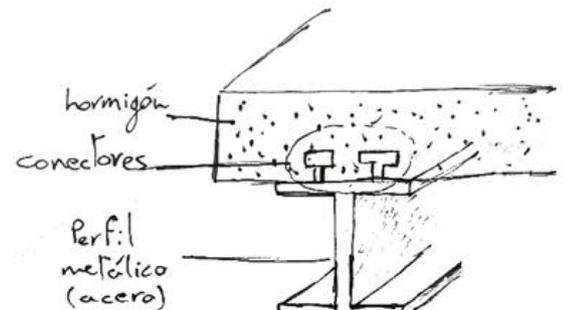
Esquema estructura mixta. Elaboración propia.
